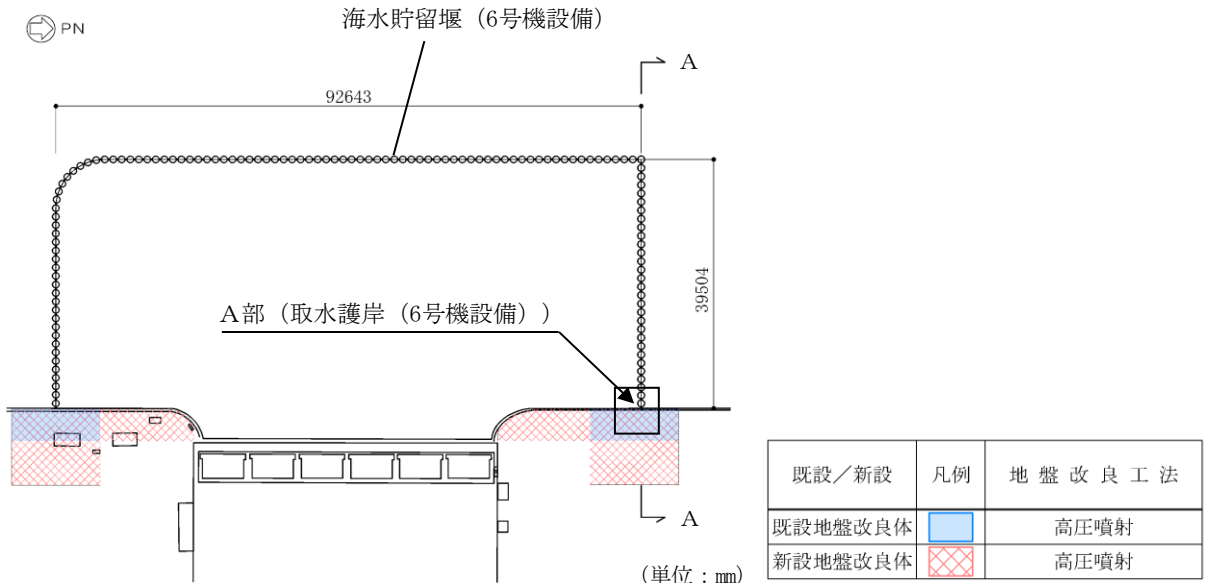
(1) 取水護岸（6号機設備）の平面図
